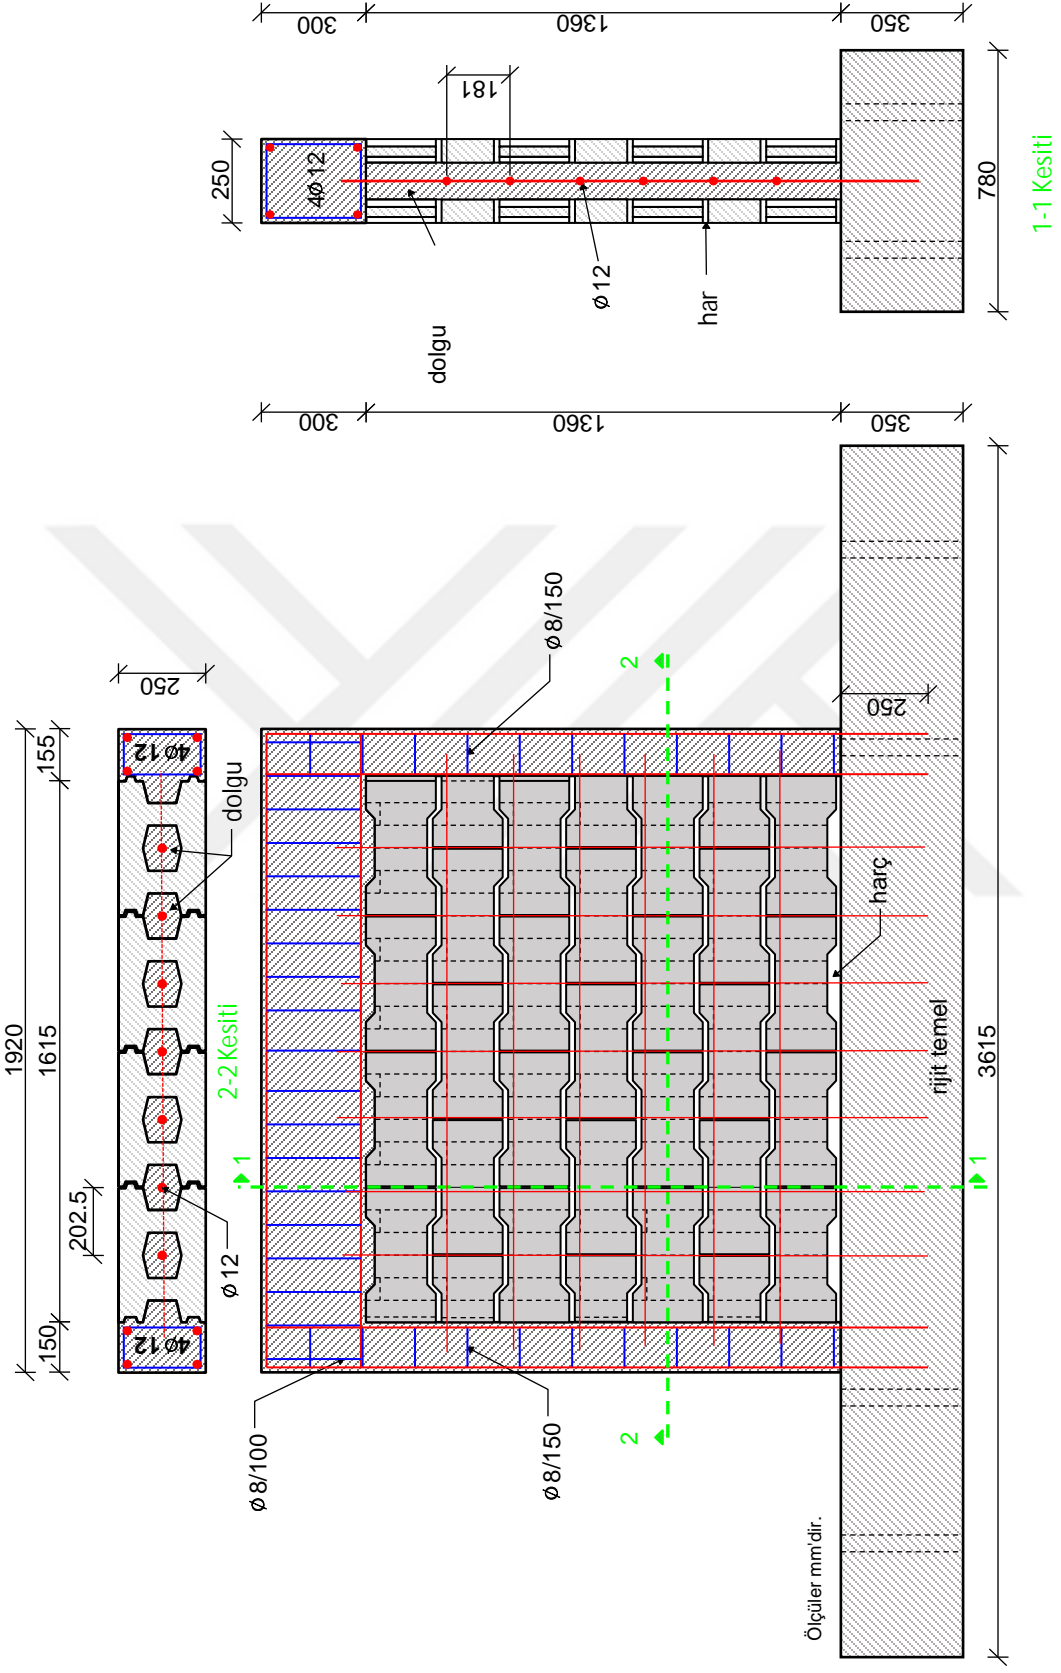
KYDDE-1 deney elemanı boyut ve donatı detayları
